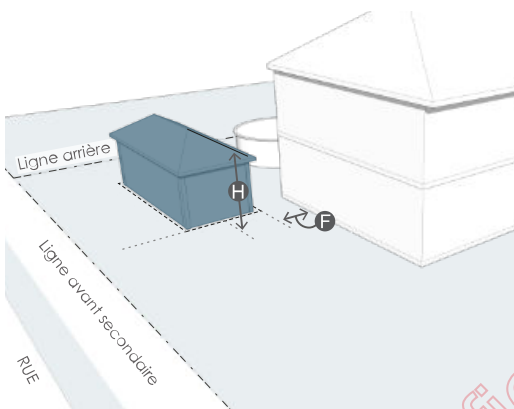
Distance minimale du bâtiment principal et hauteur maximale d'un pavillon de bain
